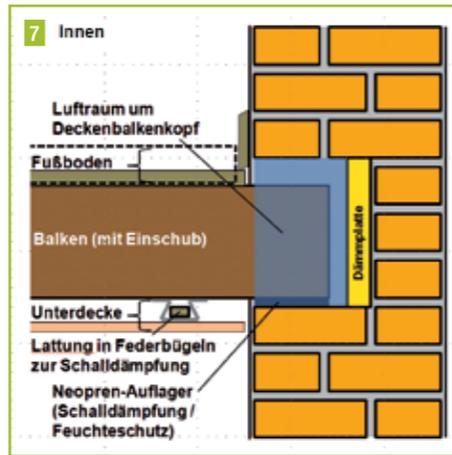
Minimalausführung für ein Balkenkopfaufleger mit stirnseitiger Dämmplatte .
